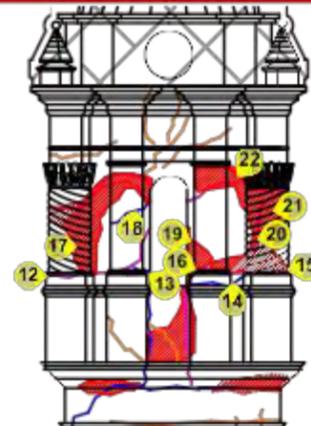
Detalle de deterioros en parte baja de segundo cuerpo de torre, fachada norte
